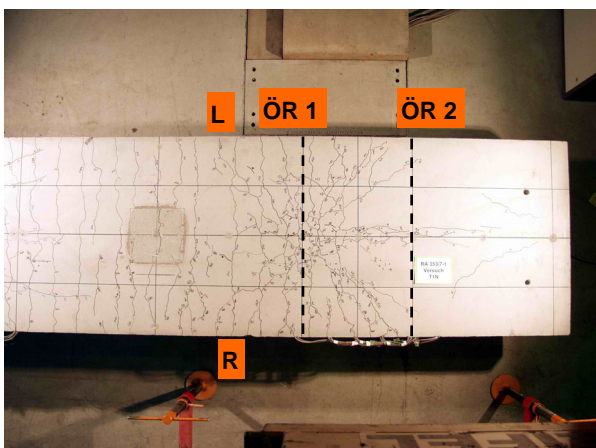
Rissbild auf der Betongurtoberseite
